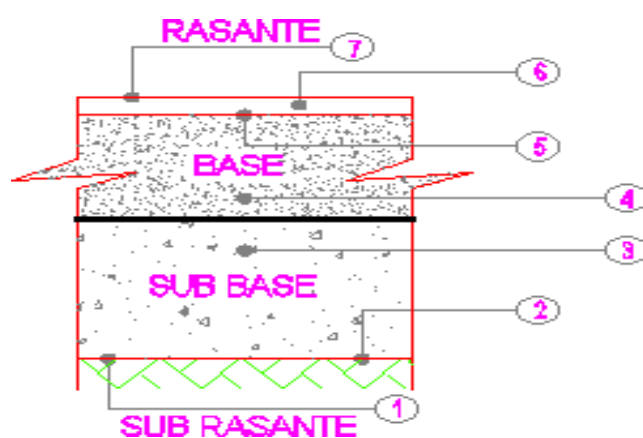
Espesores del pavimento reforzado con geomalla triaxial
